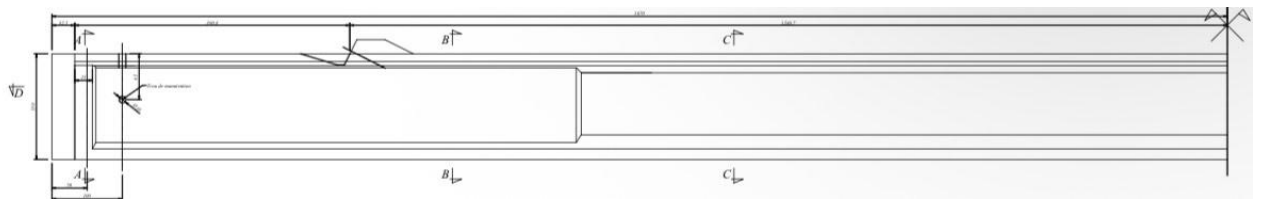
Vue en élévation de poutre de travée intermédiaire
